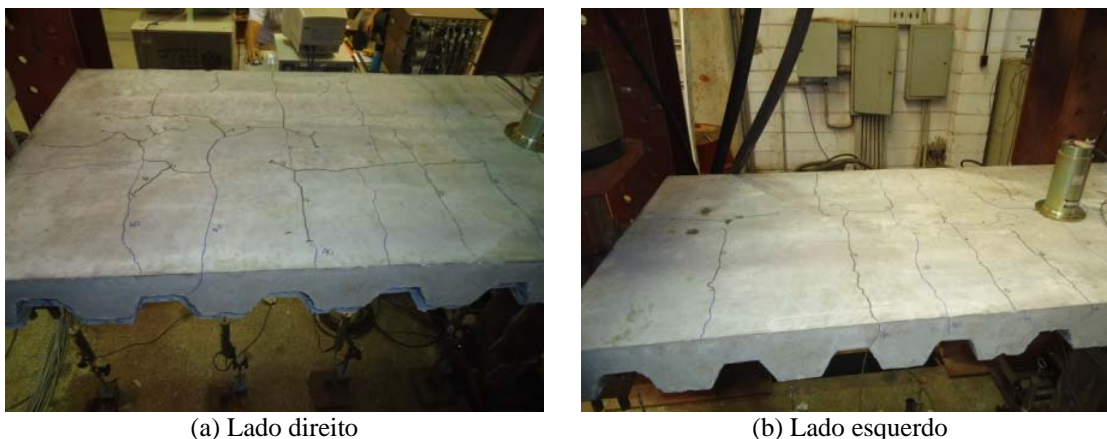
Fissuração na laje do Modelo 1.
